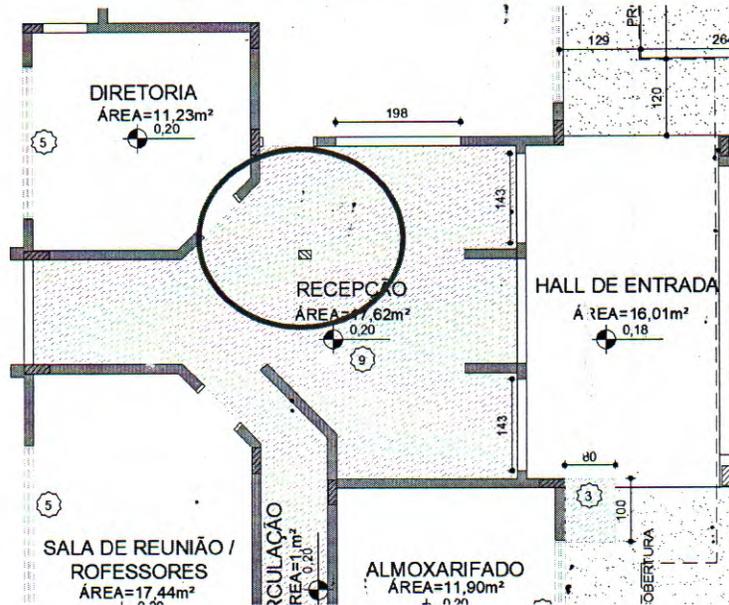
Arquitetura - Pilar executado de maneira incorreta.
